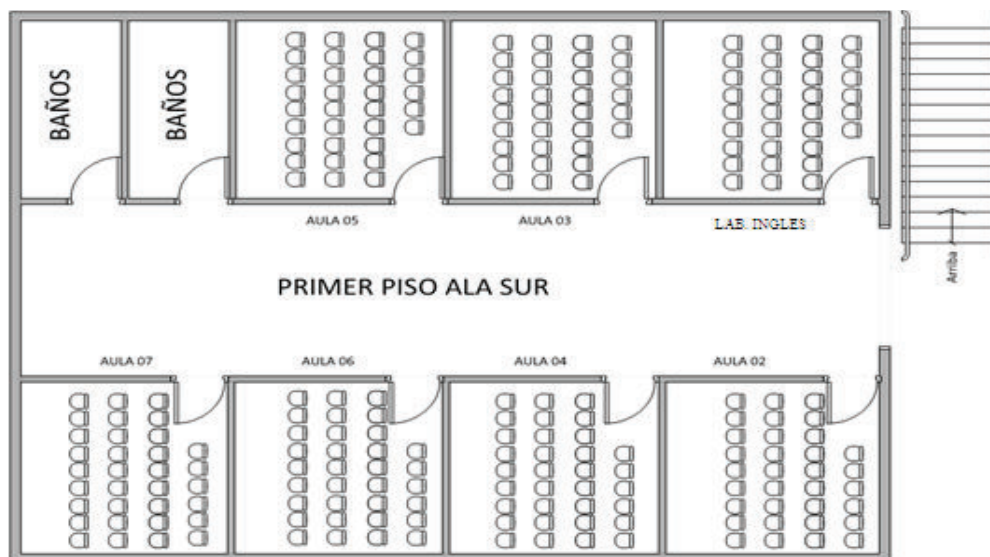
Distribución de las áreas Primer Piso ala sur
